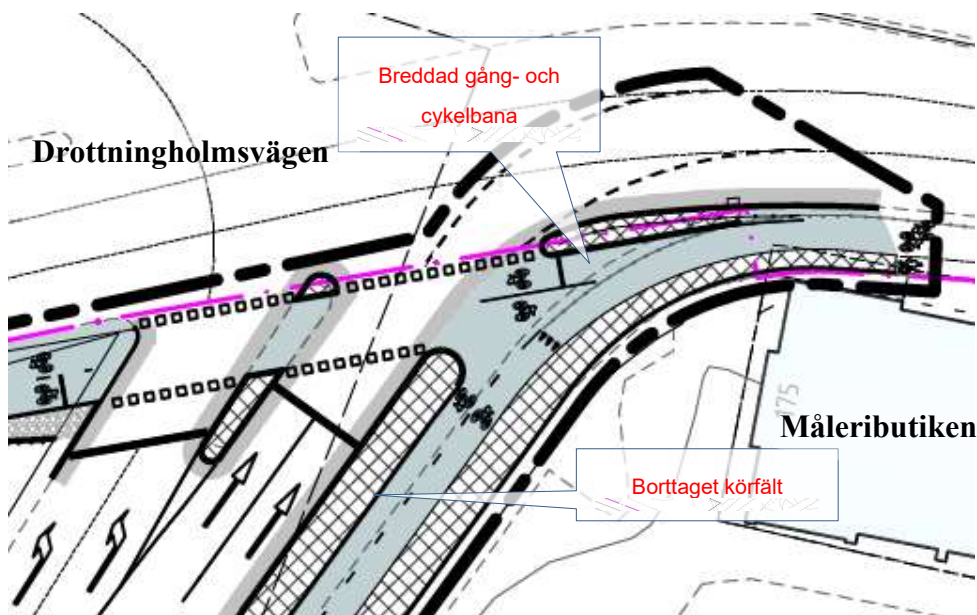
Plan, ny cykelbana rakt fram förbi Alviksplan
